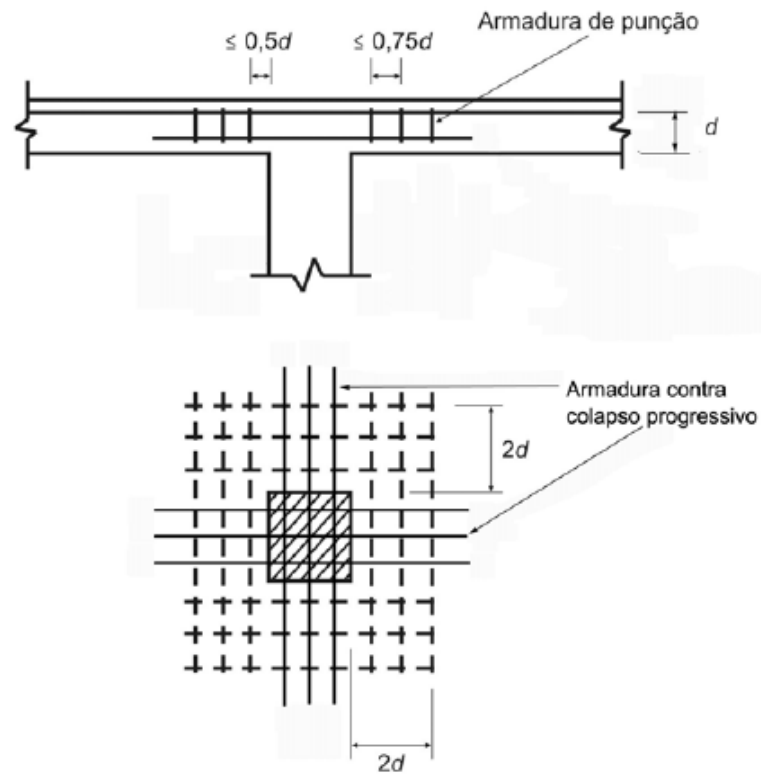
Disposição das armaduras de flexão nas lajes sem vigas
